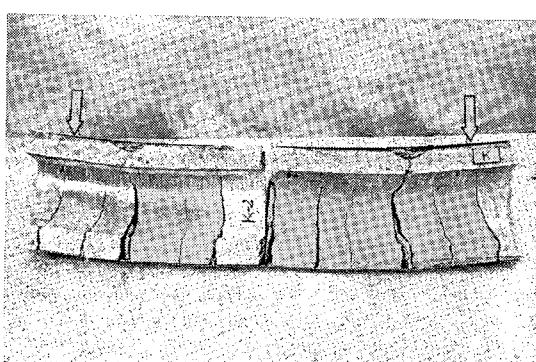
鋼管の内厚が1.4mmの中空钢管コンクリート合成部材の曲げ試験後の縦断面
